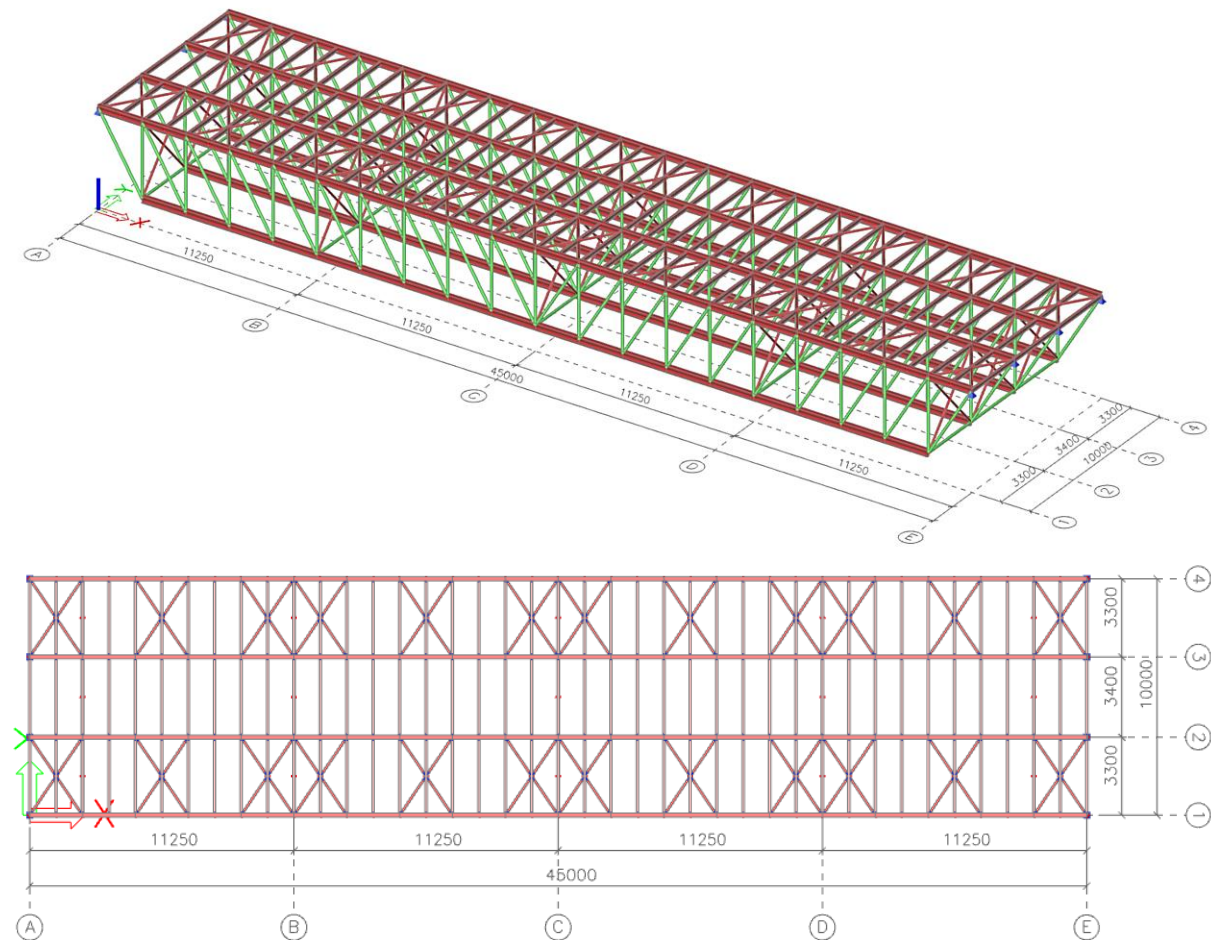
Modelo estrutural de treliça plana com banzos paralelos, tipo Pratt, perspectiva e vista superior.
